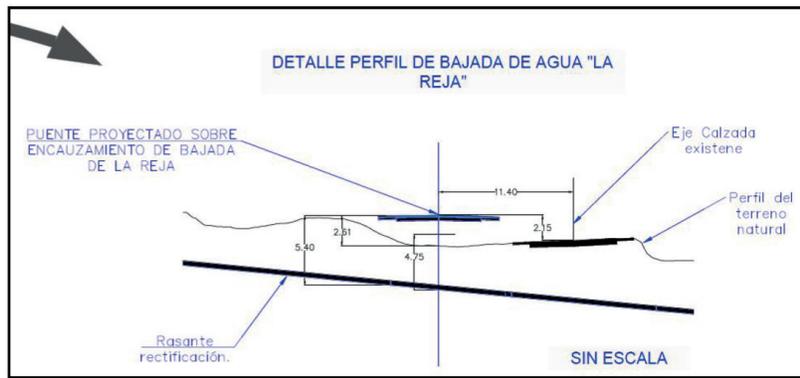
Detalle del perfil transversal de la solución prevista para Arroyo "La Reja"
